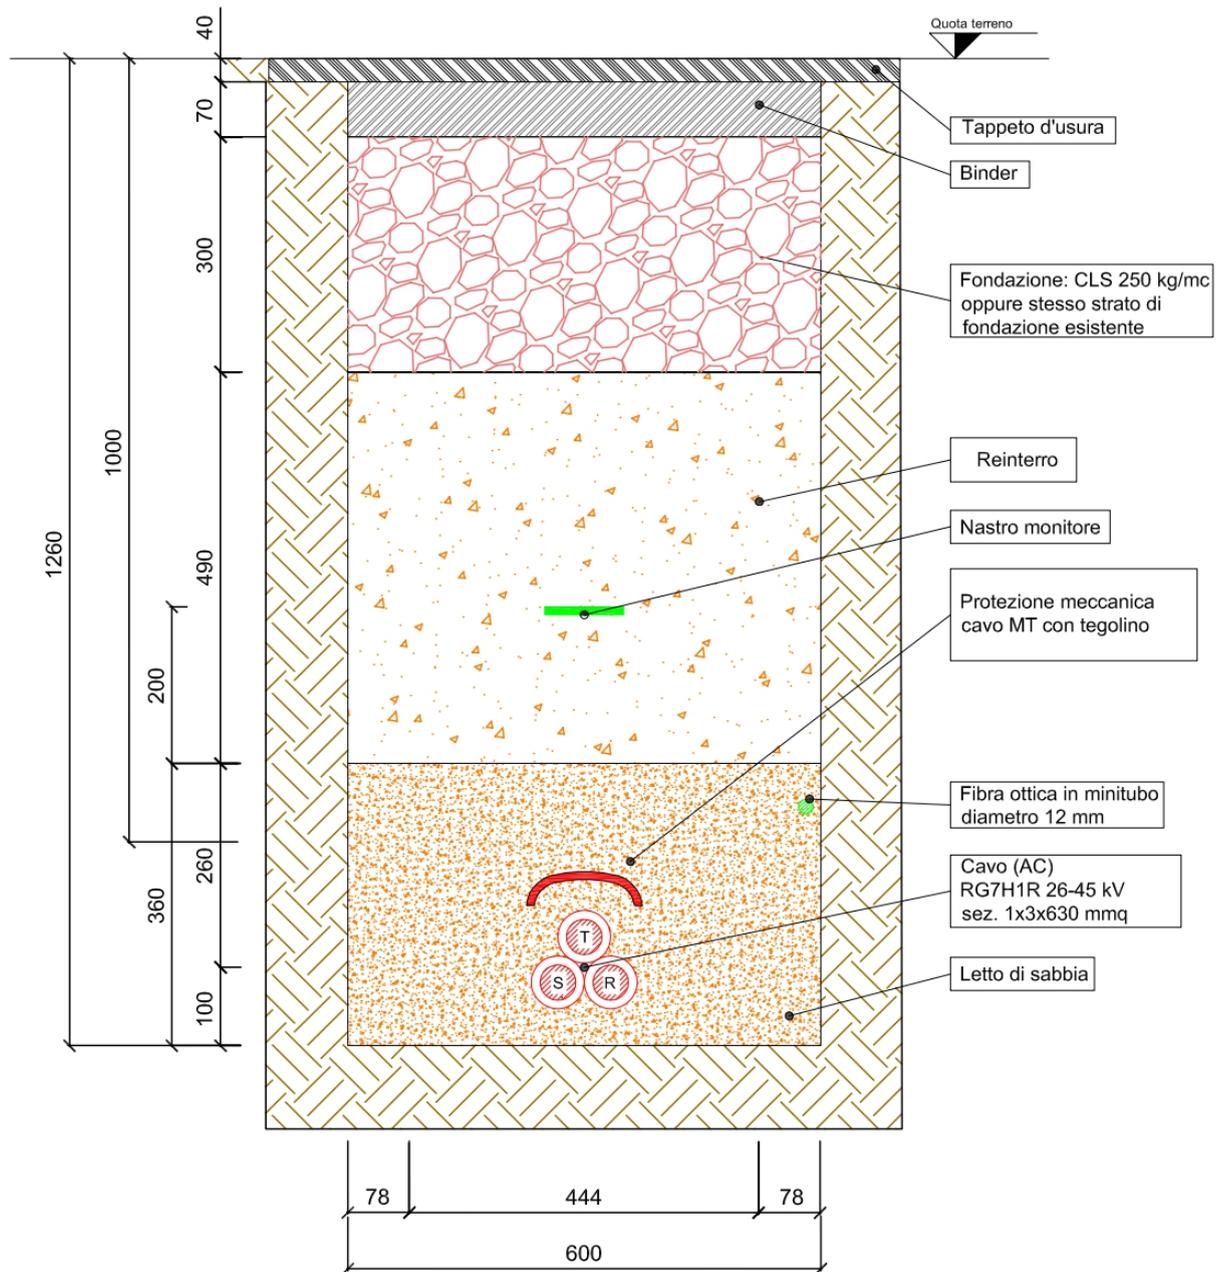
Tipico sezione di posa con un cavidotto esterno da 3x630 mm²
